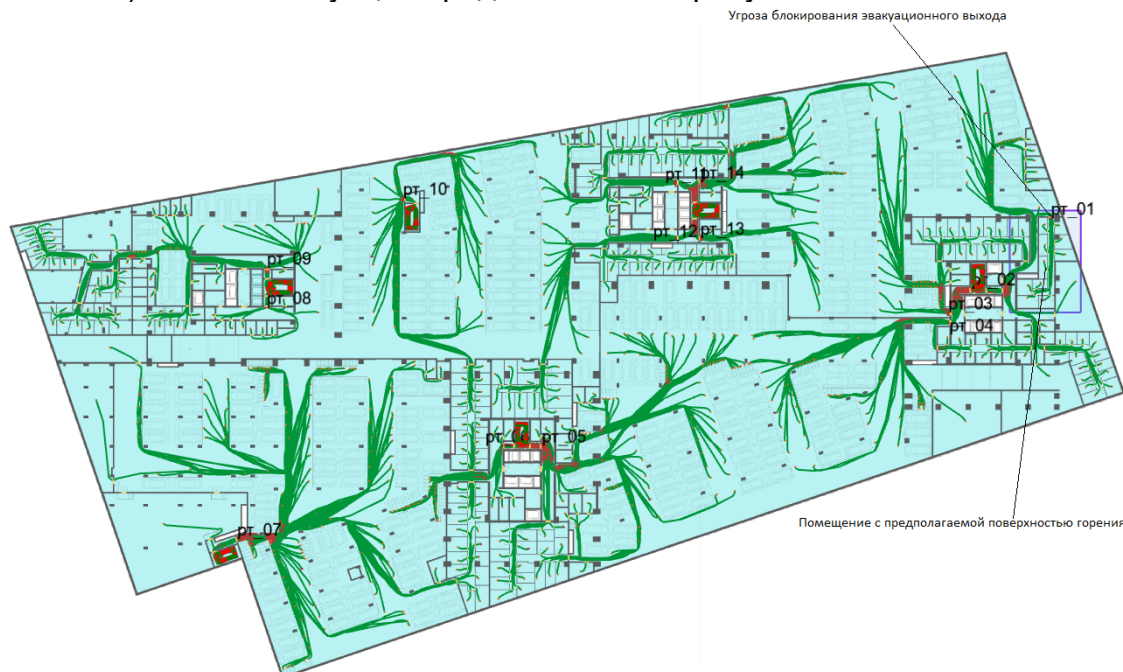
План минус 2-го этажа и нанесенная на него расчетная (принципиальная) схема эвакуации
